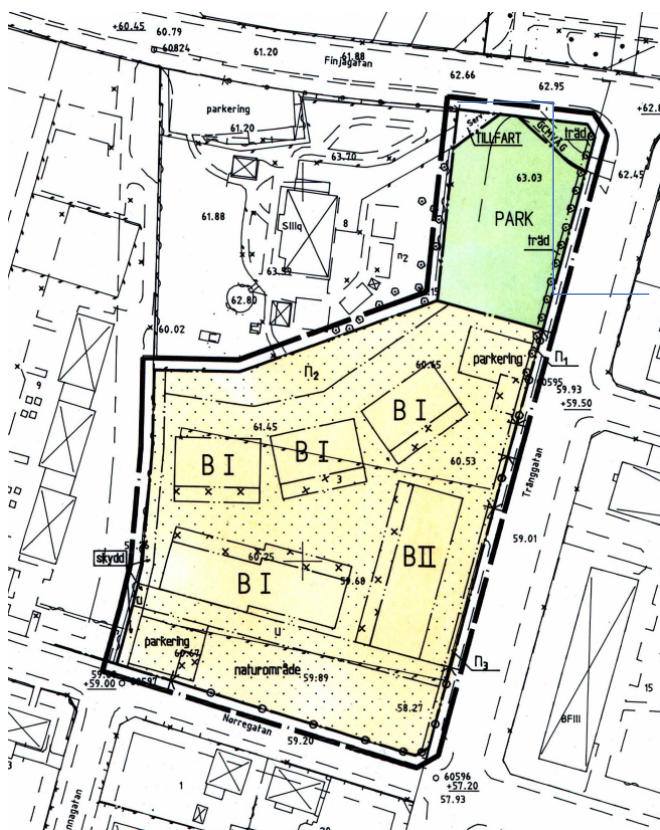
Gällande detaljplan för fastigheten Hässleholm 88:1 samt Fridhem 3.
